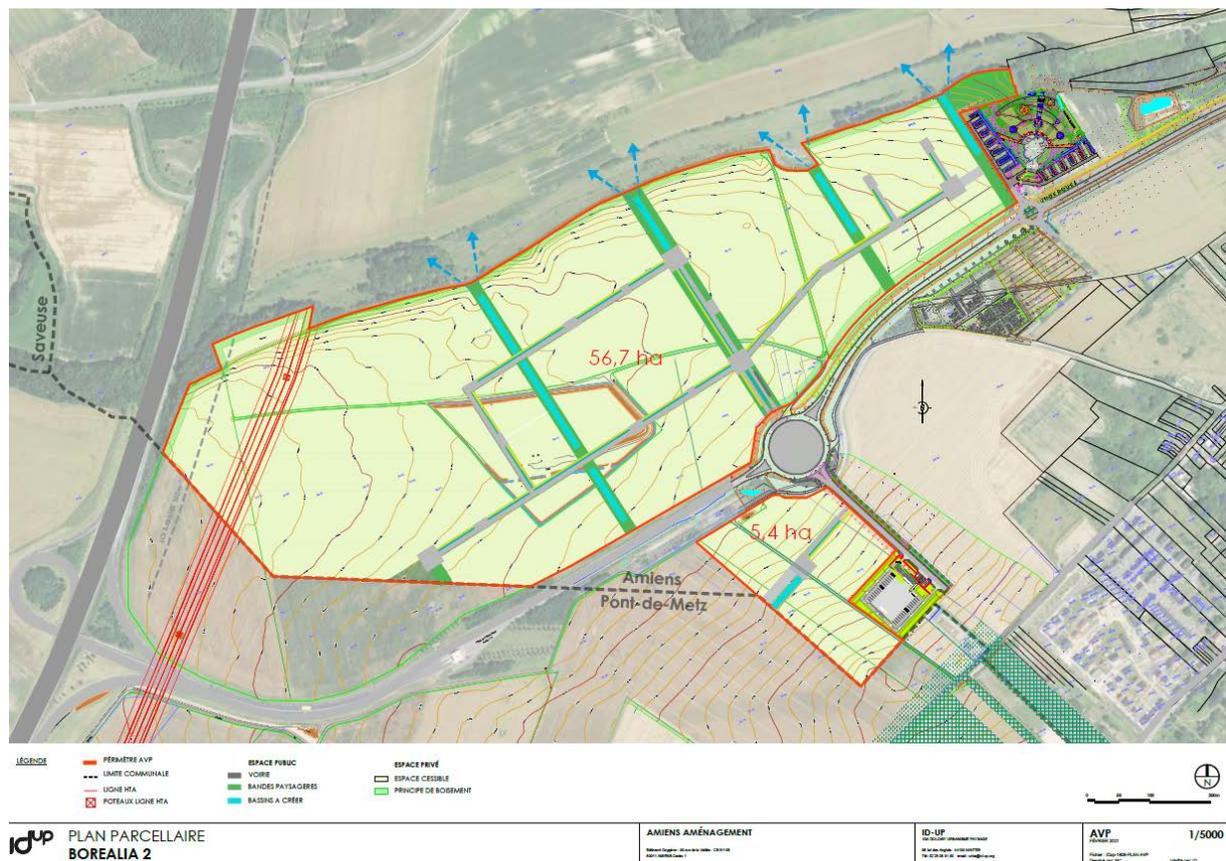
Plan des espaces verts et réseau de collecte des eaux pluviales
